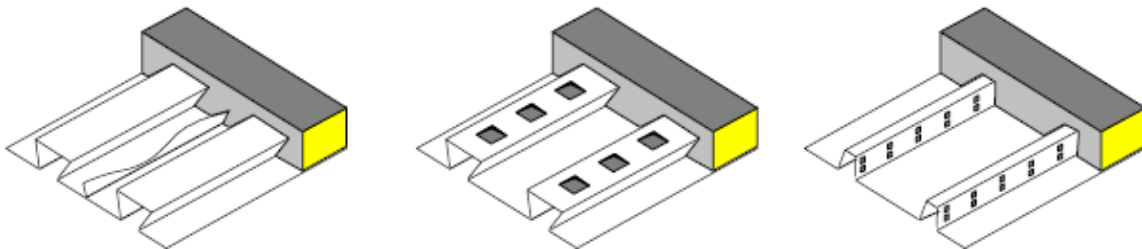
liaison mécaniques dans les dalles mixtes.
